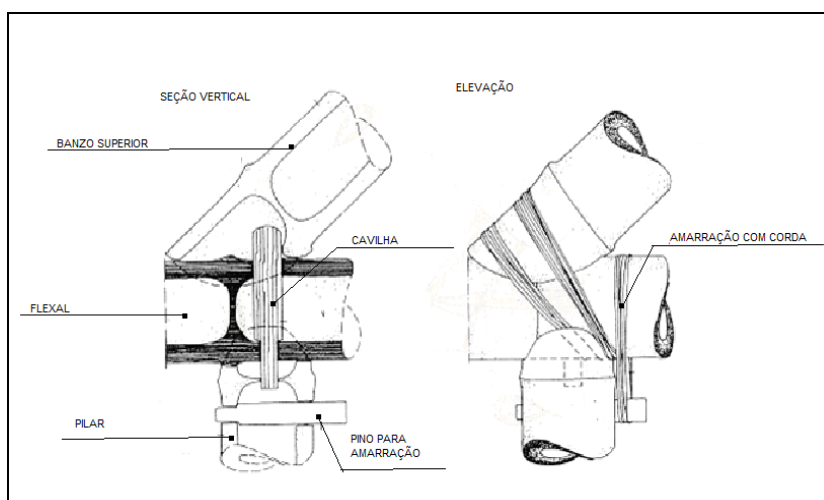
Conexão diagonal com elementos verticais e horizontais em flexal de estrutura de cobertura
